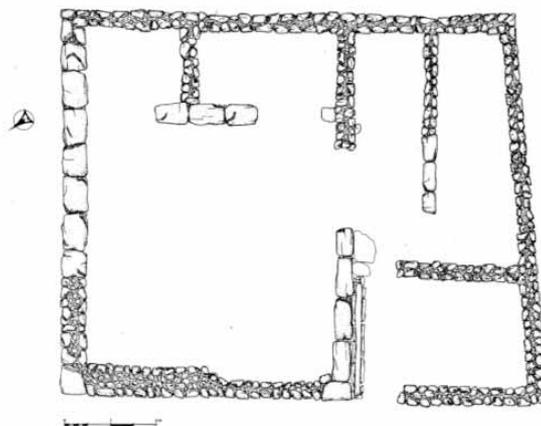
Casa Urbana di tipo I. Planimetria (Sec. IV-III c.C.)
